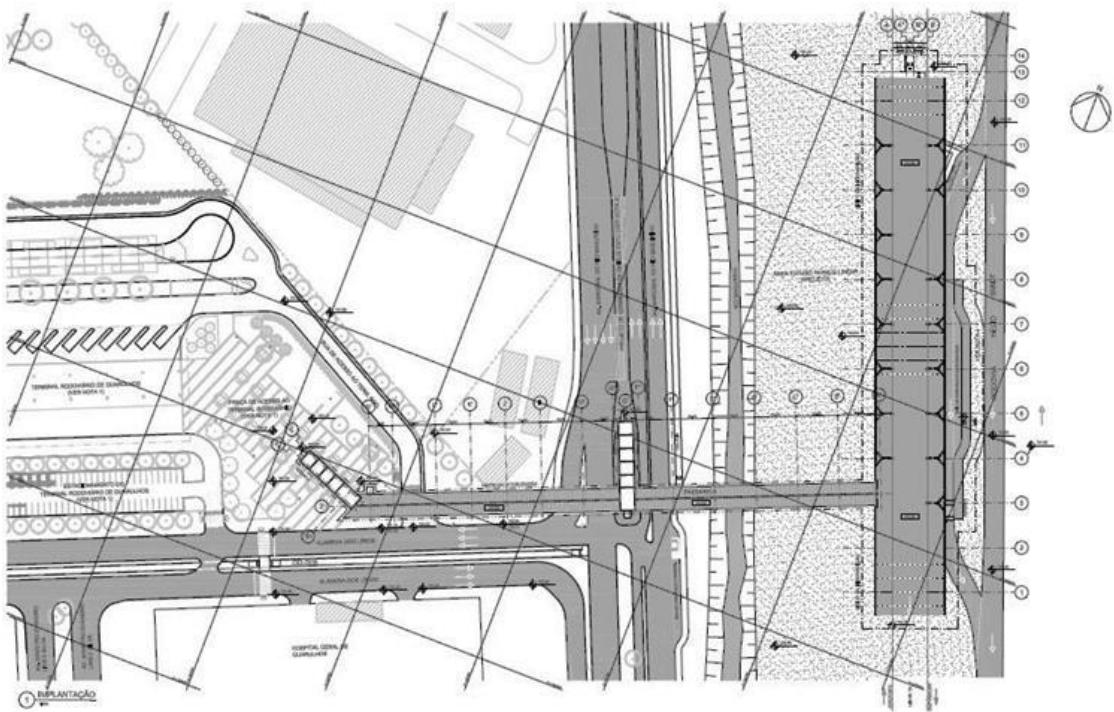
Planta Geral de Implantação - Estação Guarulhos - CECAP (CPTM, 2013).
